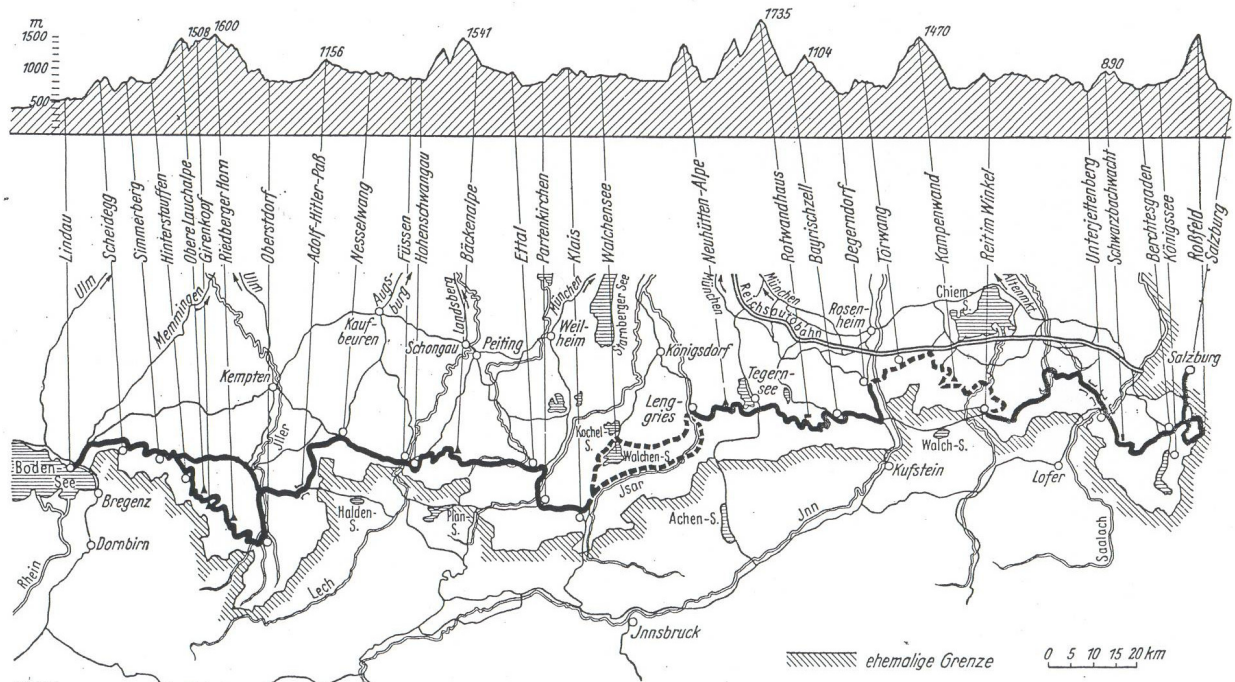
Lageplan und Längsschnitt der geplanten deutschen Alpenstraße (Anonymus, VDI – Zeitschrift Sept. 1939)
